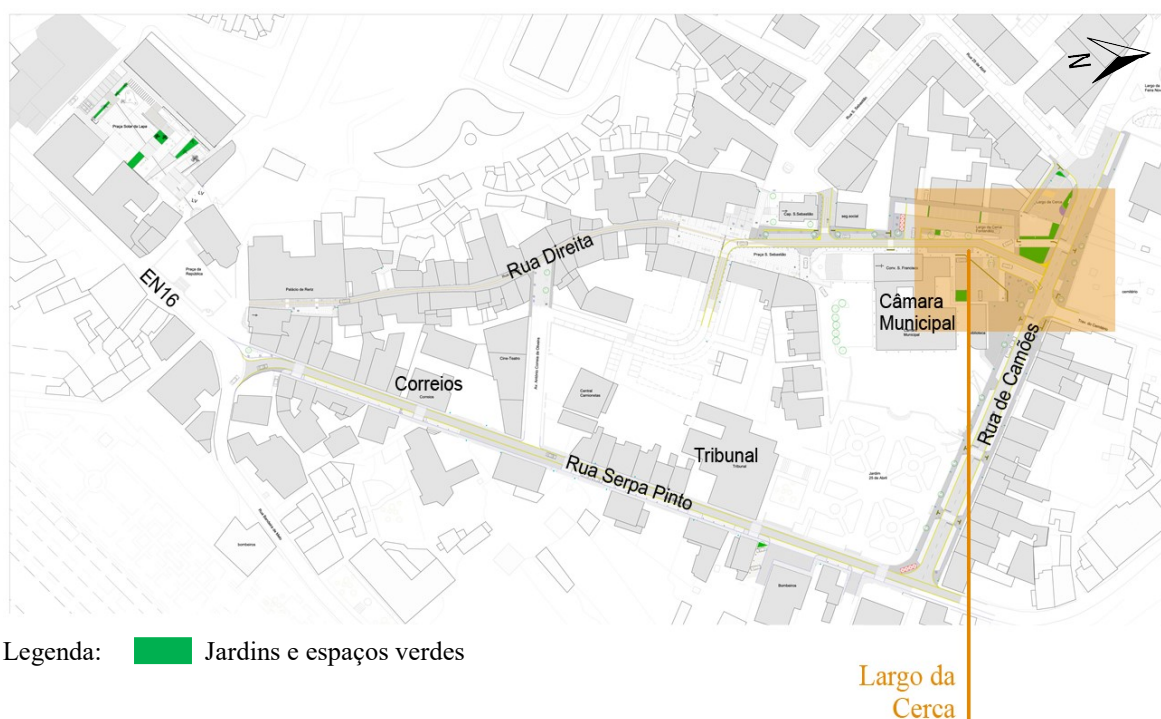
Largo da Cerca – planta esquemática (s/esc.)
